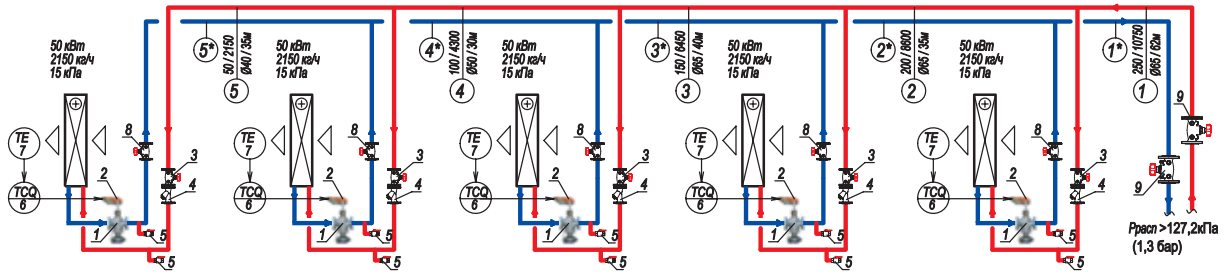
Расчетная схема системы теплоснабжения калориферов воздушного отопления
